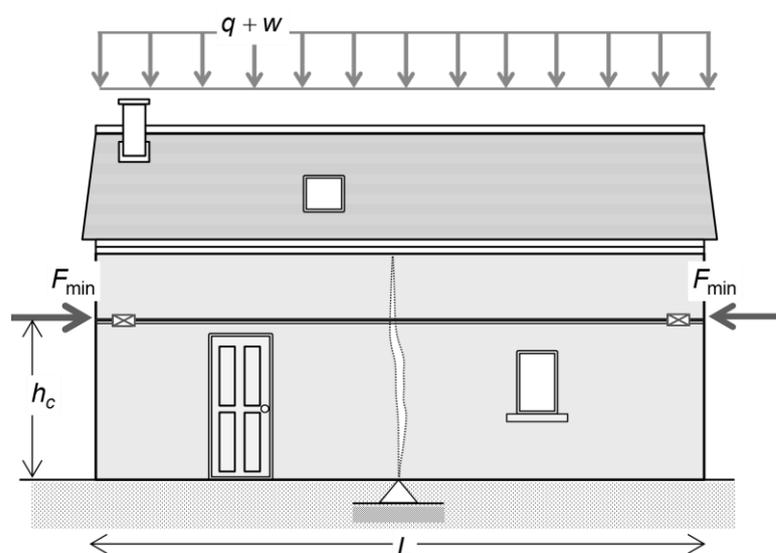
schéma de calcul de la force minimale permettant la stabilité
